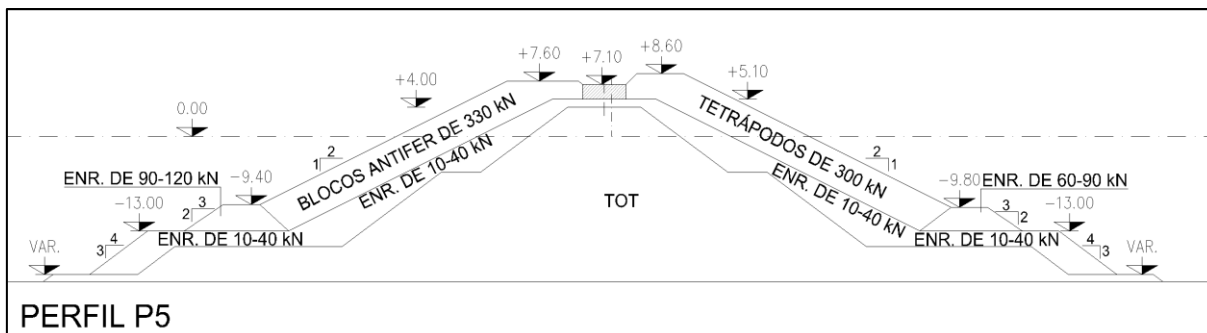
Perfil Transversal Tipo P5, construído em 1985
